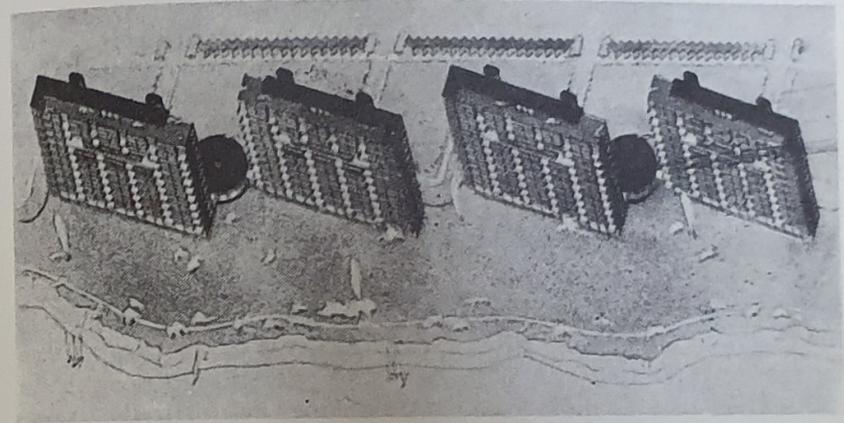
Walter Gropius. Proyecto de bloques de viviendas para la urbanización de las márgenes de un río. Todas las viviendas gozan del mismo asoleamiento.
